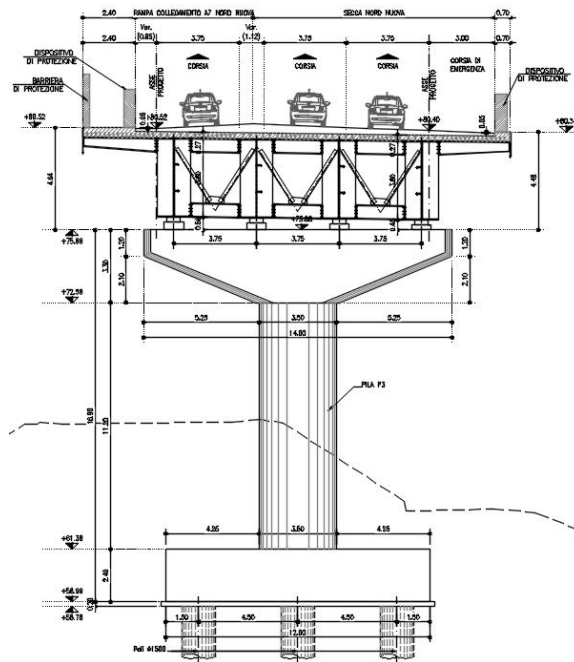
Pila a mensola - Sezione trasversale Pila P3
